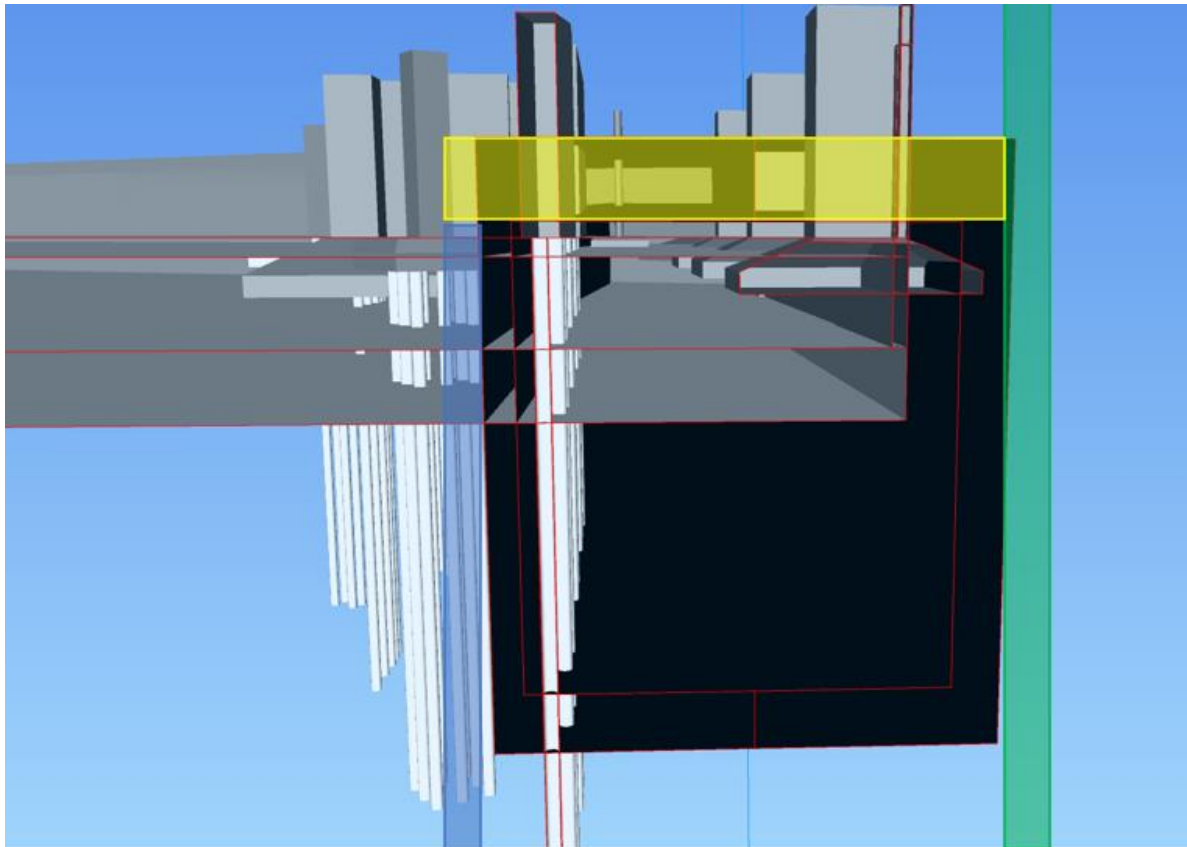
Querschnitt durch den Tunnel beim Bieberhaus mit den Abfangkonstruktionen
